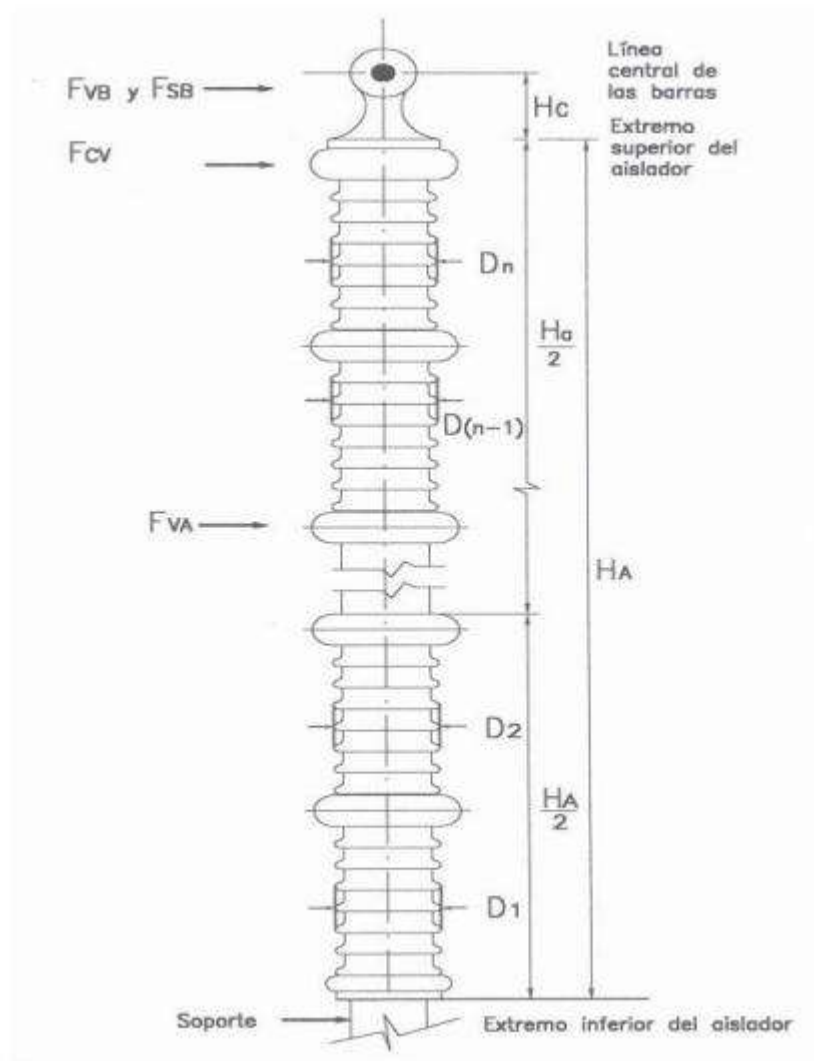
10: Fuerzas en un aislador con montaje vertical
